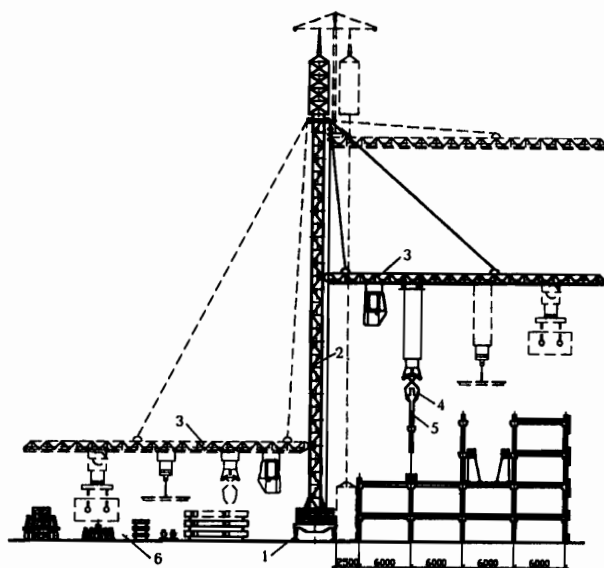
Монтаж конструкций многоэтажного здания краном-манипулятором с двумя вертикально перемещающимися по башне стрелами: 1 – ходовая часть; 2 – башня; 3 – вертикально-перемещаемые стрелы; 4 – захватное устройство; 5 – монтируемая конструкция; 6 – зона складирования
